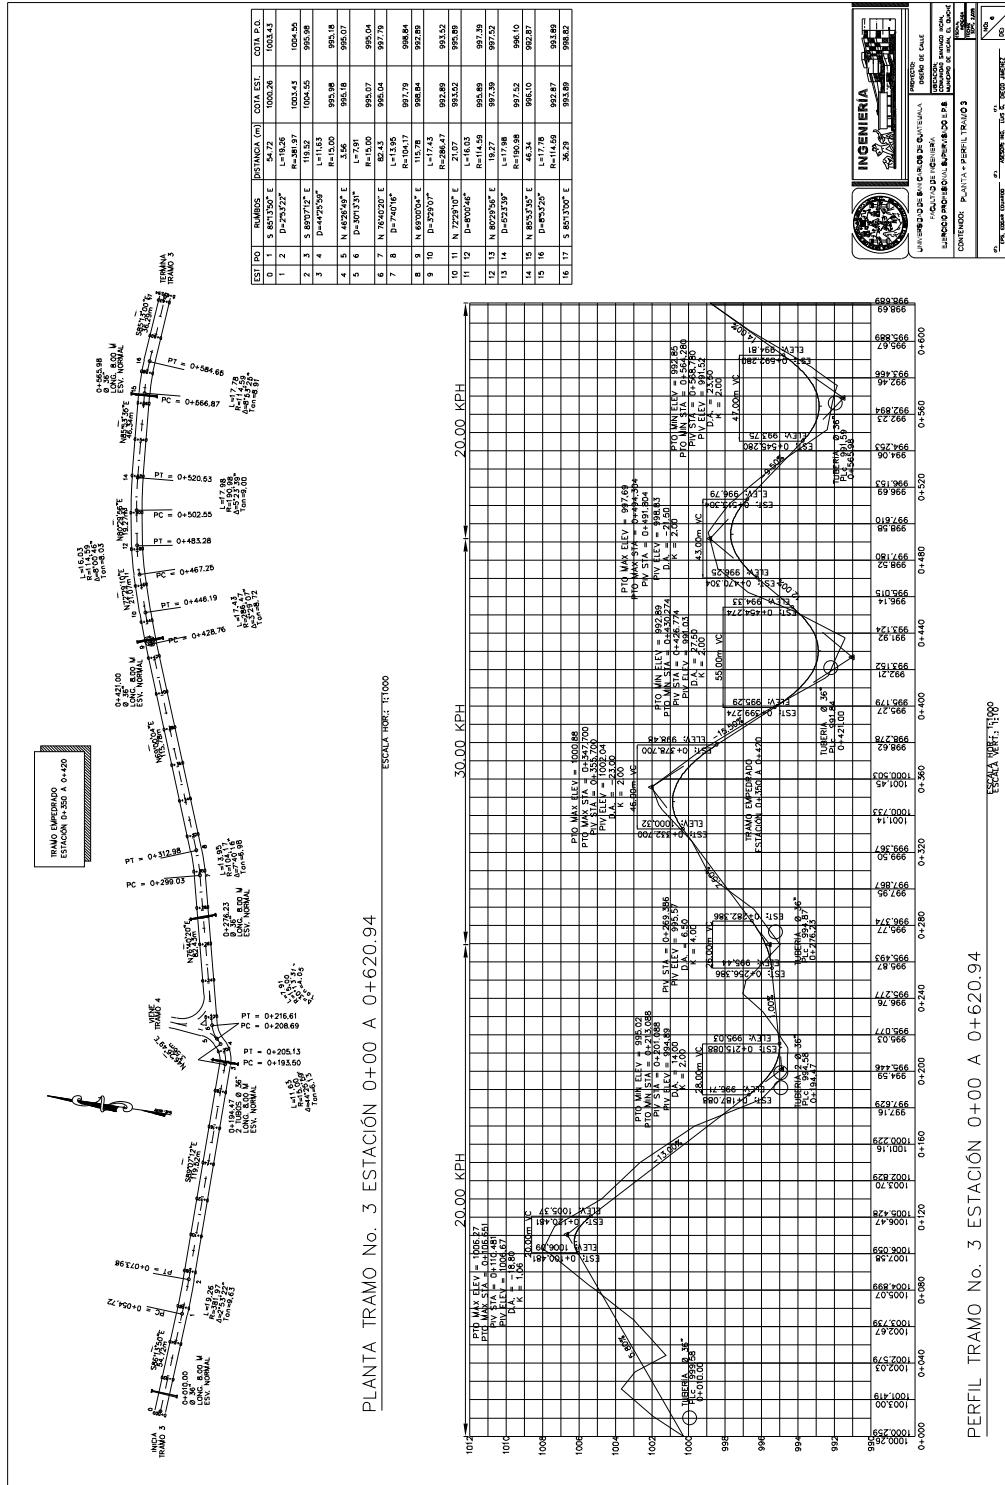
Planta-perfil tramo 3 estación 0+00 – 0+620.94.
